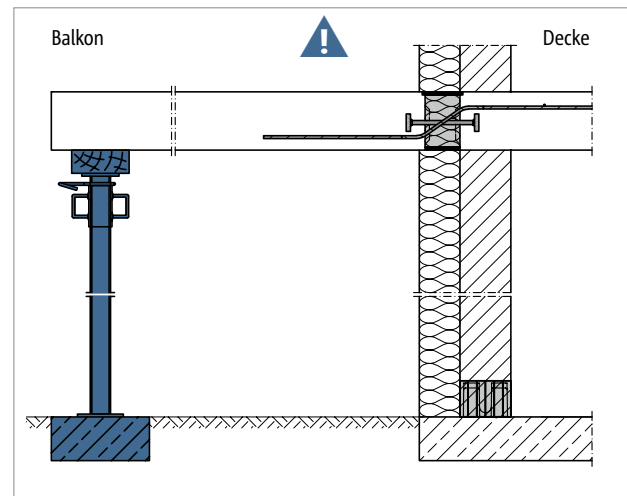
Schöck Isokorb® XT Typ QP: Stützung durchgängig erforderlich
